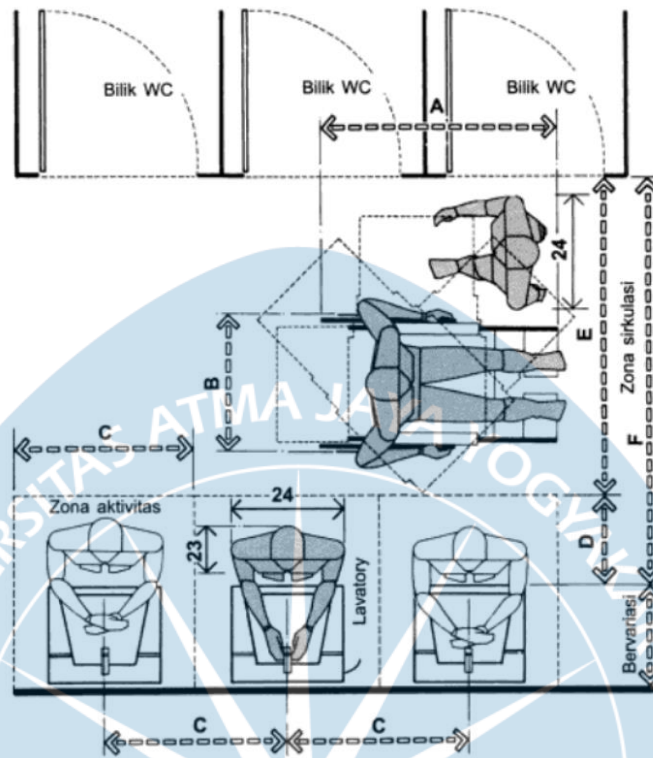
Antropometrik Bilik WC/ Pemindahan dari arah depan
